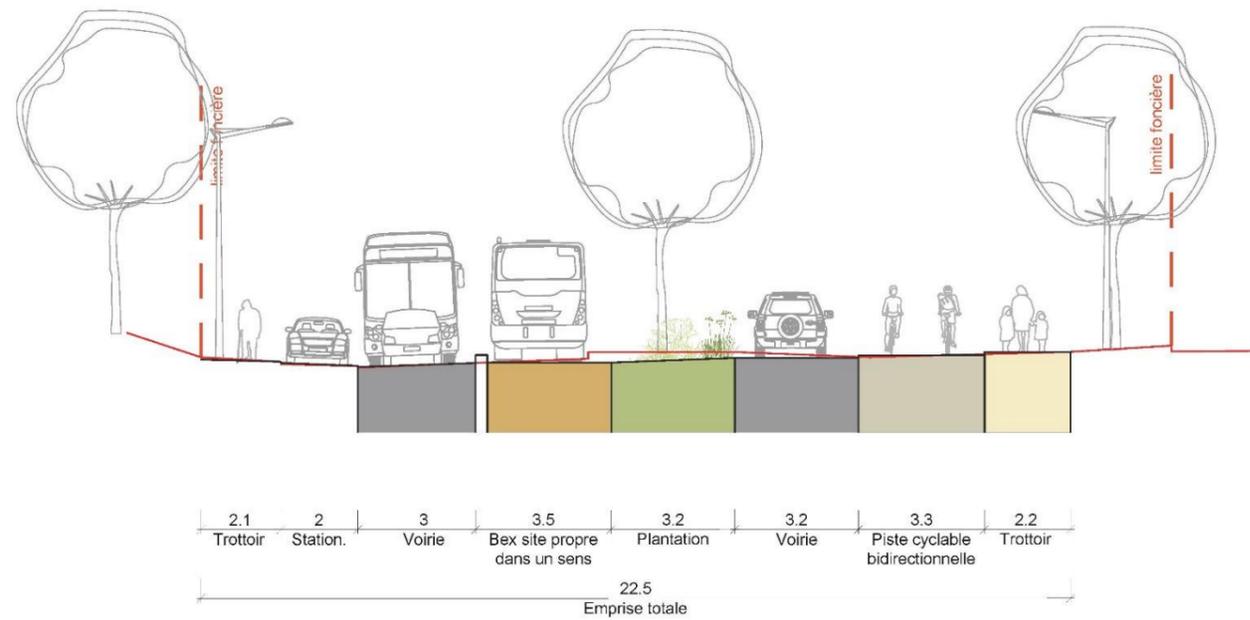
Coupe type sur la rue Arthur Rimbaud
